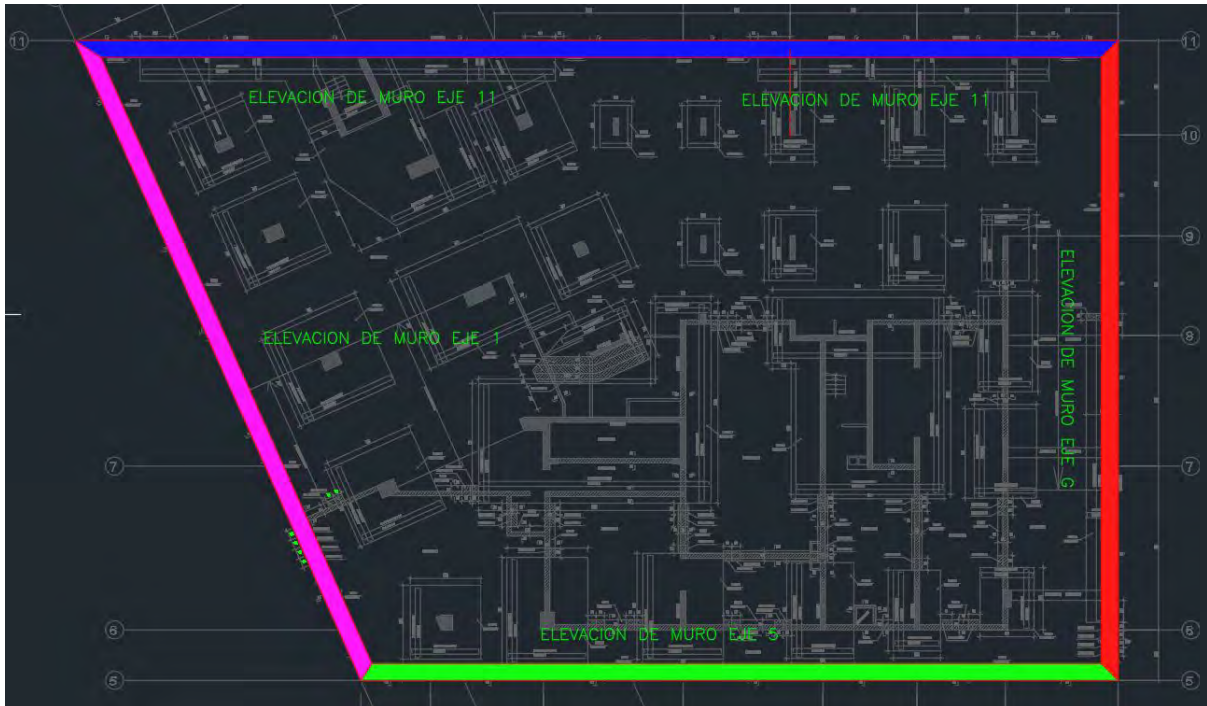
Plano en planta de elevación de anillos de muros anclados.
